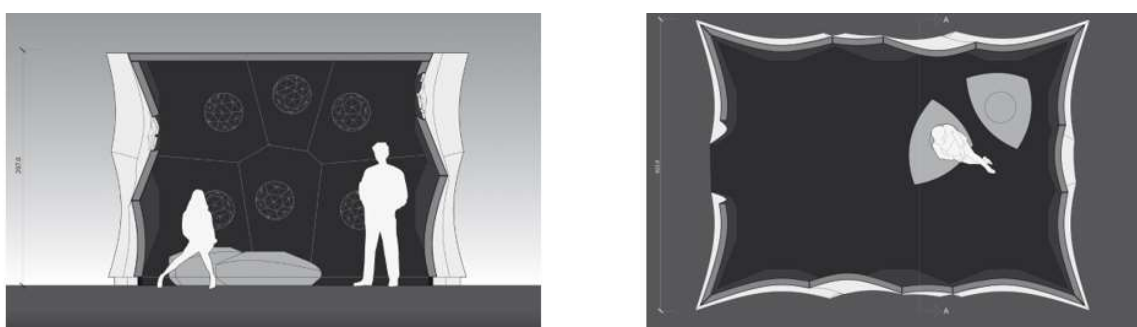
HygroSkin - Coupe (gauche) - Plan (droite) (Menges & al., 2013)
